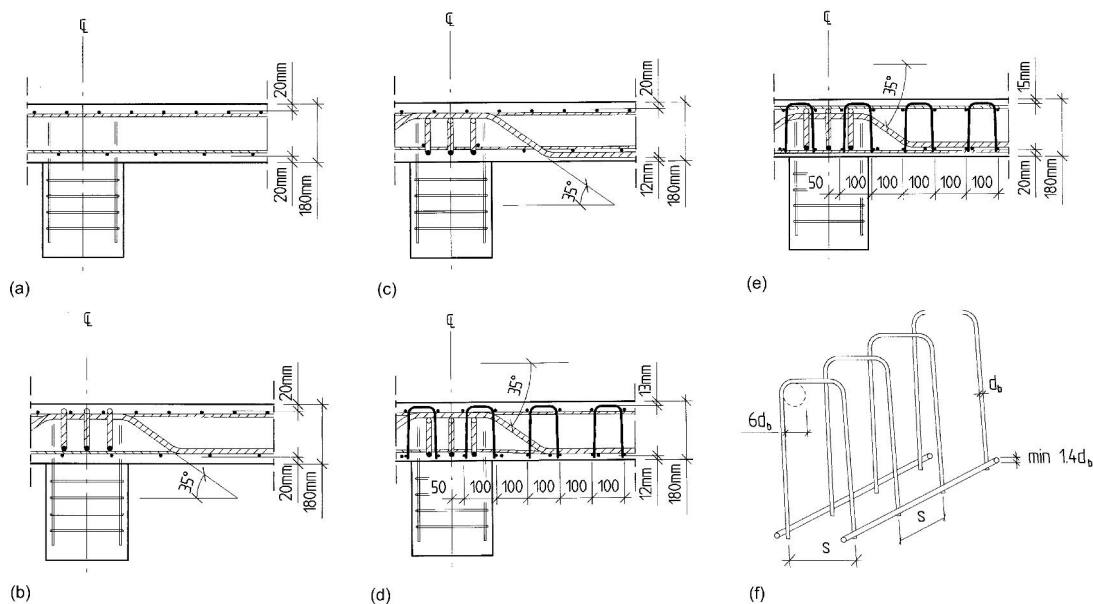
Disposição das armaduras de punçoamento: (a) Lajes 9 e 9a; (b) Laje 10; (c) Laje 11; (d) Laje 12; (e) Lajes 13 e 14; (f) "Stirrup cages" [10].
